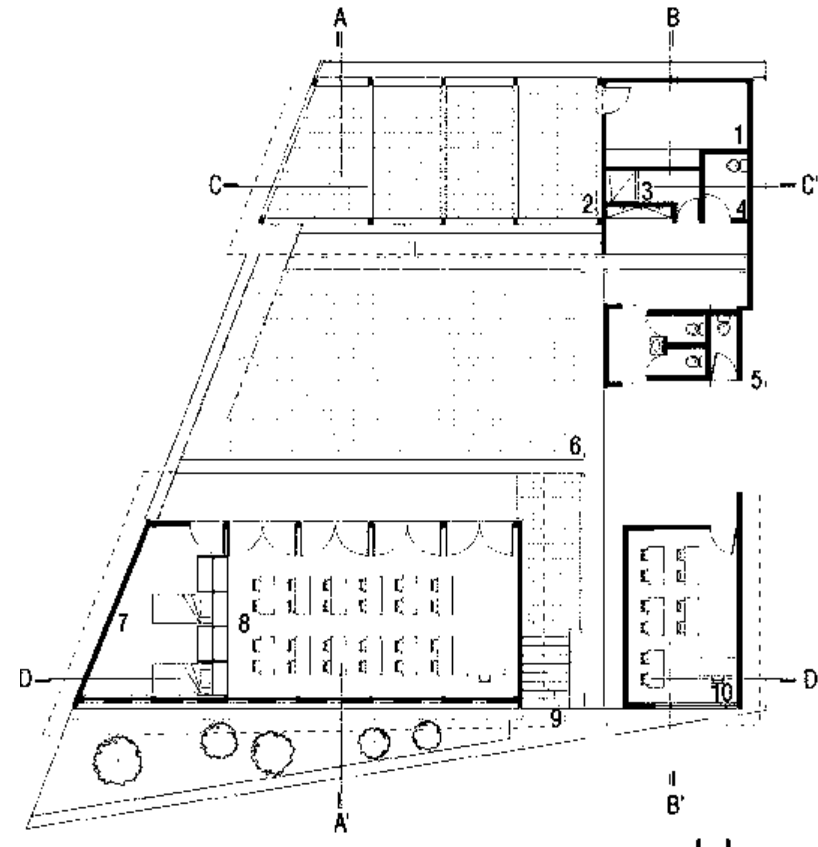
Arquitectónico 1 en <http://www.plataformaarquitectura.cl>
